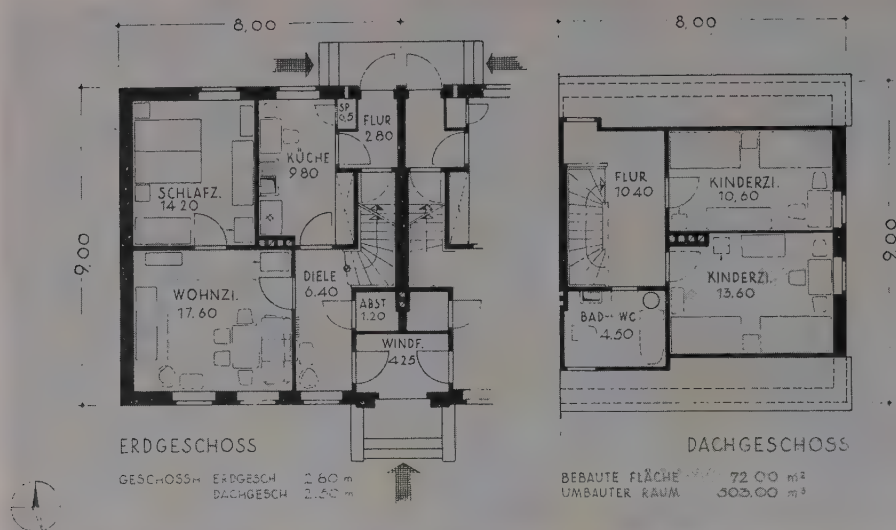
4-Zimmer-Doppelwohnhaus für Landarbeiter und Traktoristen, Vorschlag für Brandenburg, Grundriß Erdgeschoß und Dachgeschoß
